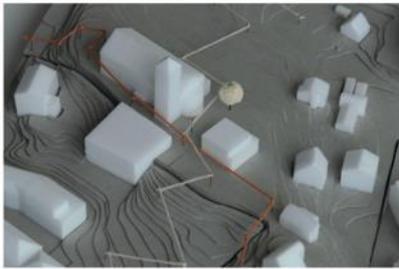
Variante 3b - Allseitige Orientierung mit Attikageschoss
